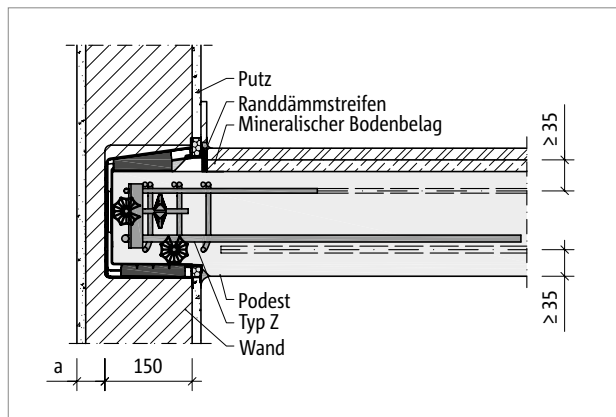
Schöck Tronsole® Typ Z: Brandschutzausführung
